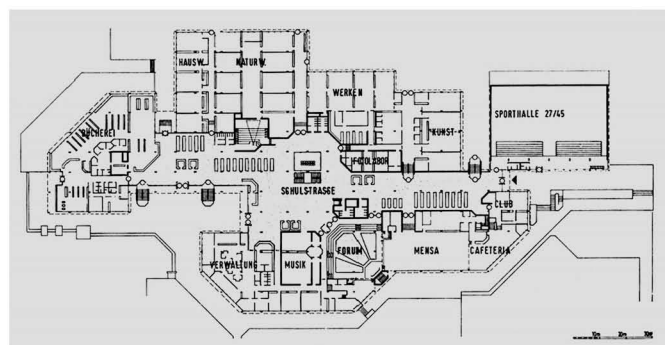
IGS Braunschweig-West: Grundriss Erdgeschoss (Pysall, Jensen, Stahrenberg 1976, S. 331).
